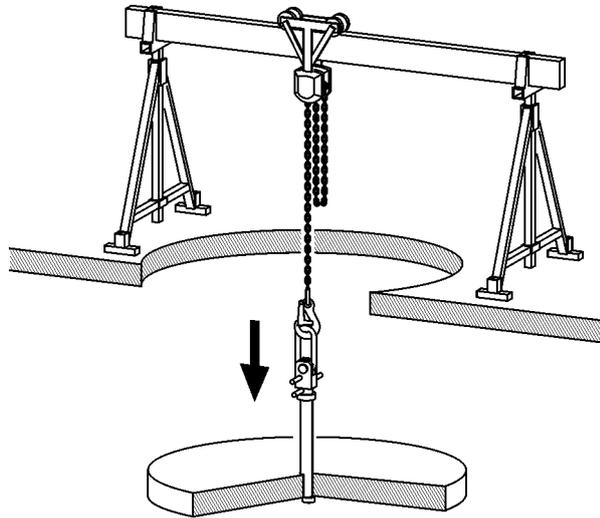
Dispositivo de remoção no exemplo de recorte no pavimento
